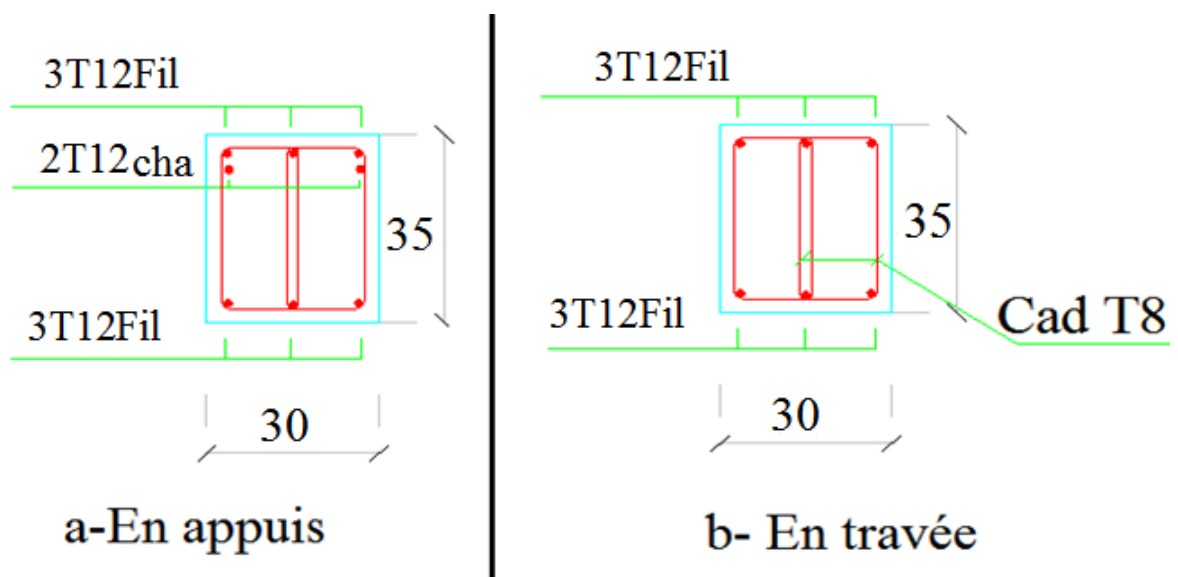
Ferrailage des poutres secondaires d'intermédiaire.
